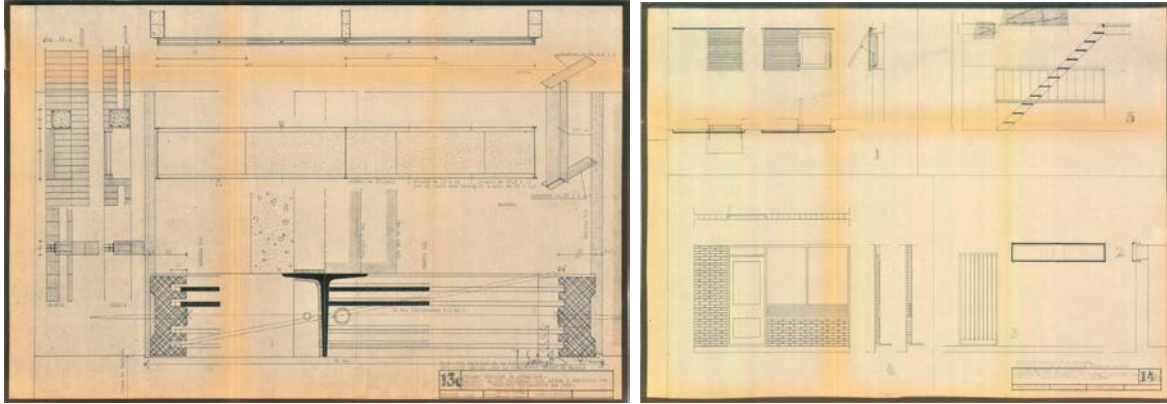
(izda.). Entrevías, Primera Fase, Plano 13c, Vivienda tipo C, Detalles ventana corrida
